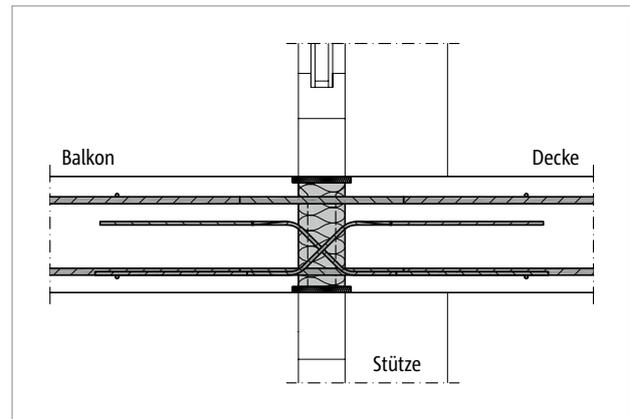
Schöck Isokorb® T Typ D: Einbauschnitt; Flachdecke
